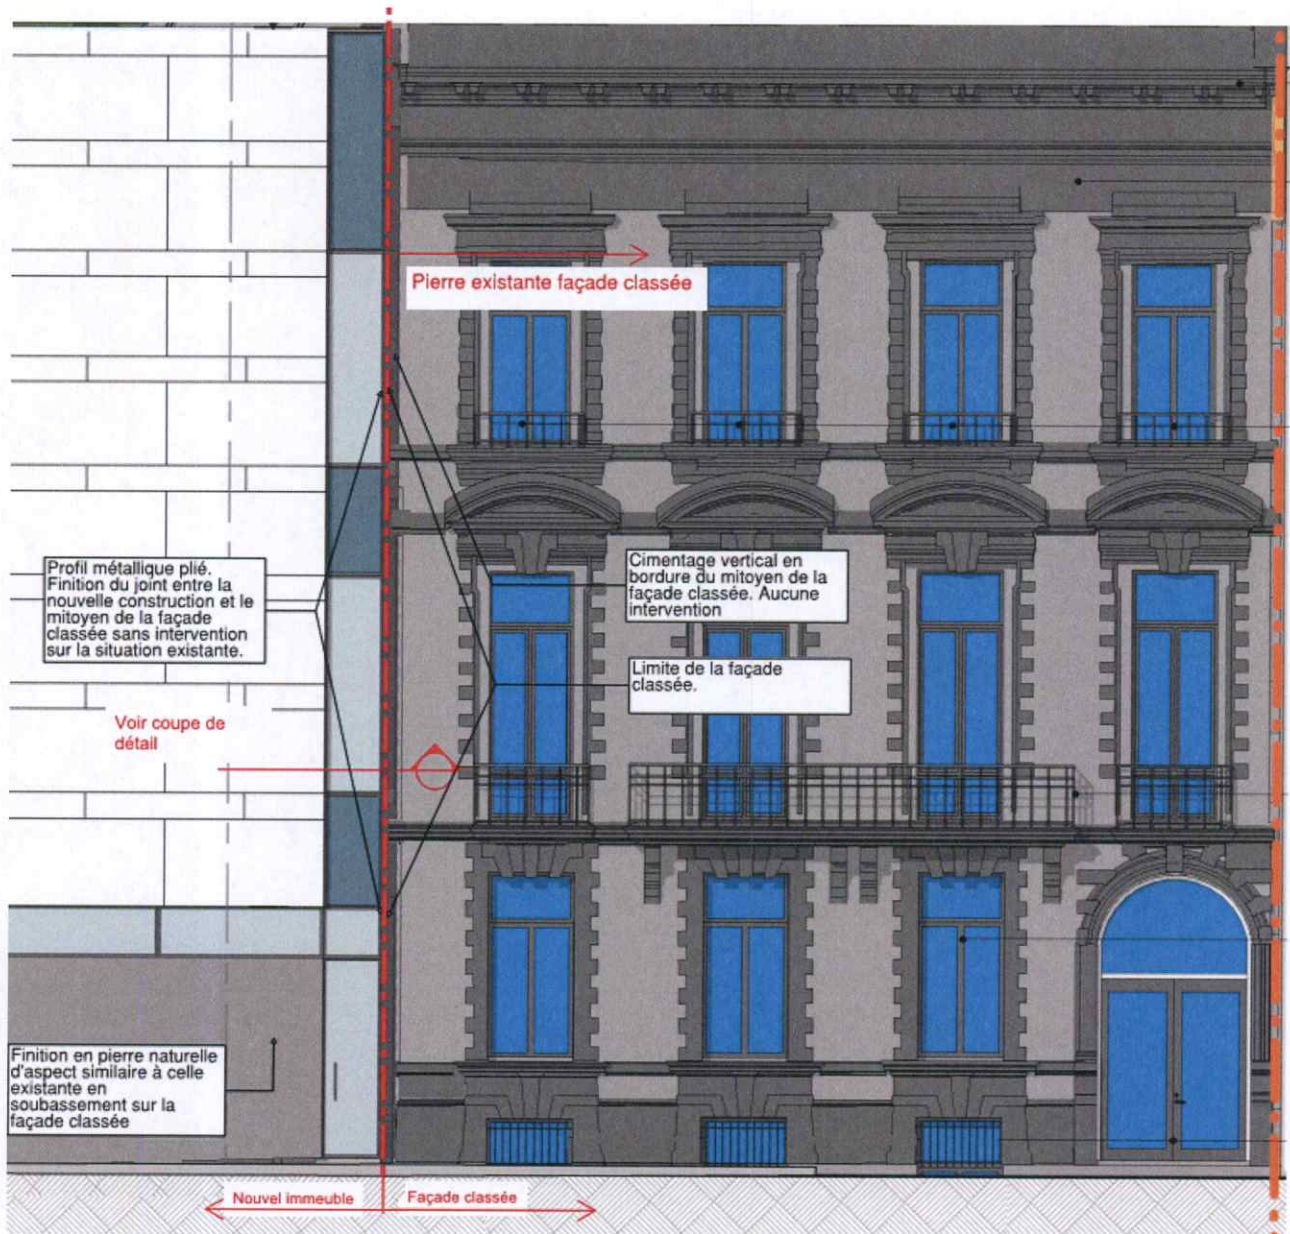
b : Projet amendé - Élévation de la zone de raccord entre le nouvel immeuble et la façade classée
